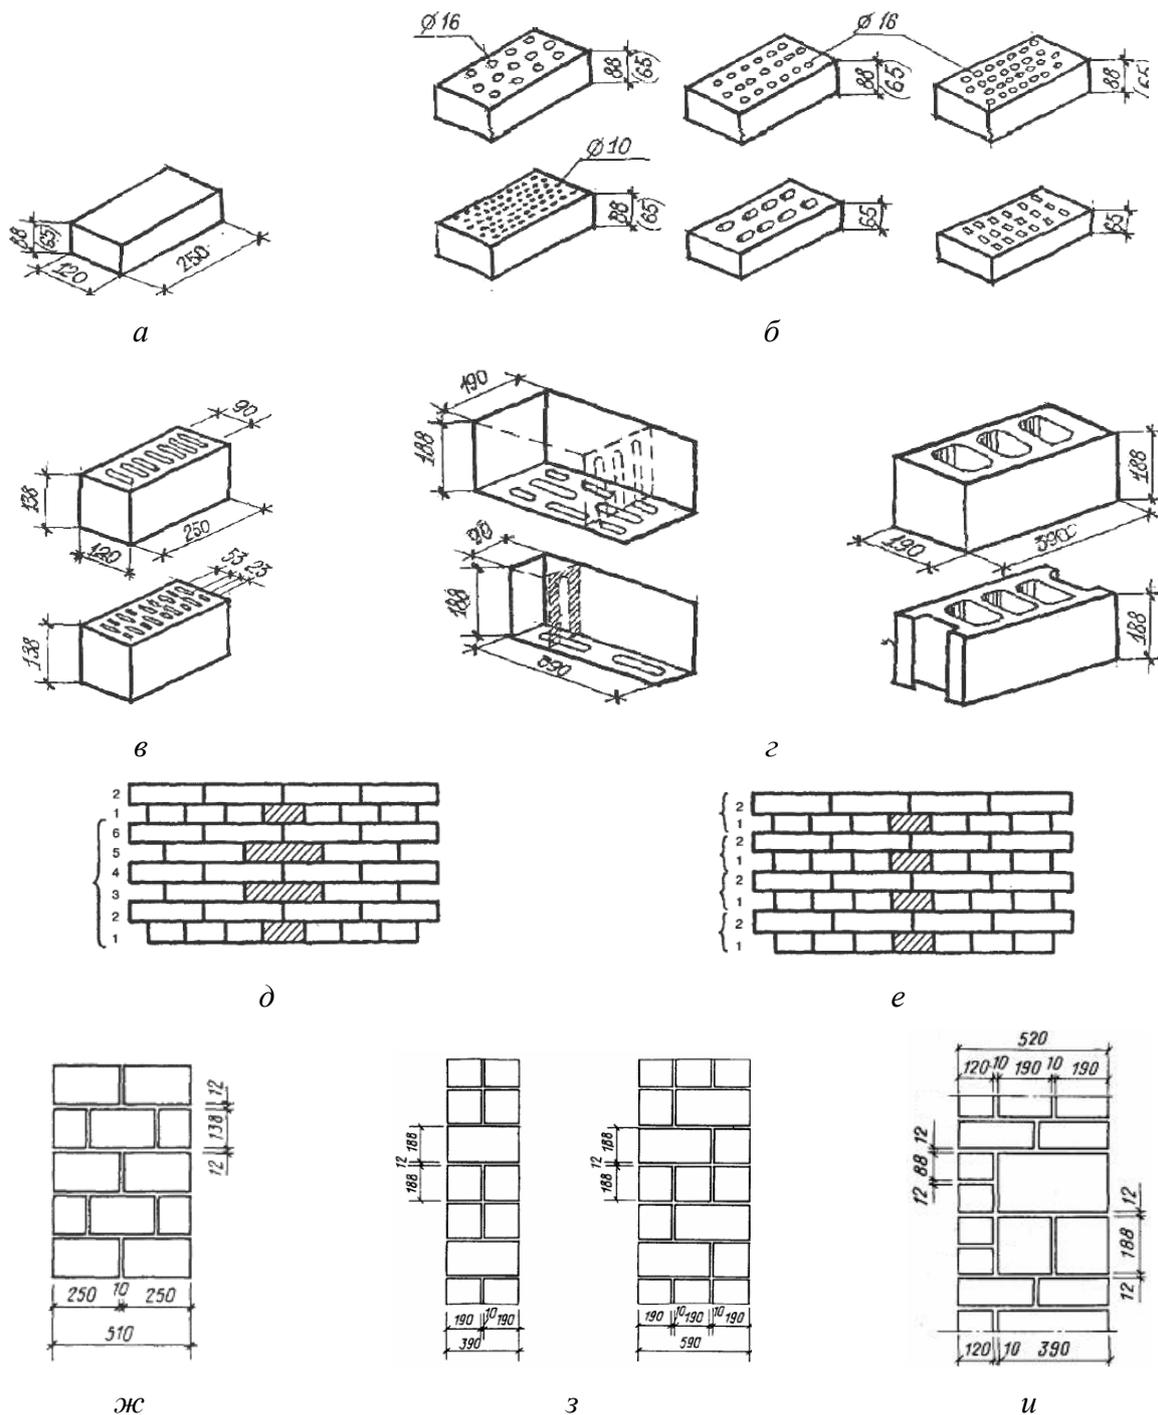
Материалы и типы сплошных кладок наружных каменных стен: *а* — кирпич сплошной; *б* — кирпич пустотелый (модульный — 88; сплошной — 65); *в* — керамические камни; *г* — легкобетонные камни; *д* — кирпичная кладка шестирядная; *е* — кирпичная кладка двухрядная; *ж* — кладка из керамических камней; *з* — кладка из бетонных и природных камней; *и* — кладка из бетонных камней с облицовкой кирпича
